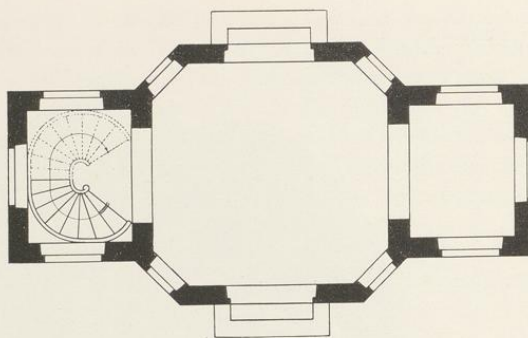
Grundriß des Hauses Wilhelmstraße 11, Rekonstruktion
